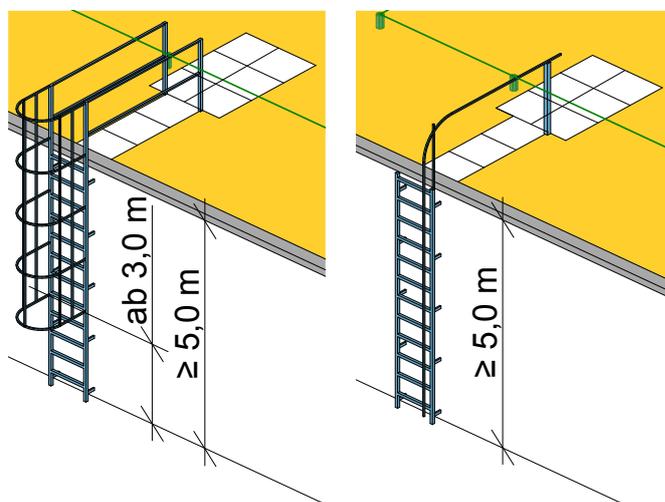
Accès par une échelle fixe avec protection dorsale ou dispositif antichute (le dispositif antichute est préférable à la protection dorsale). Le montage sur le support doit être prévu.
